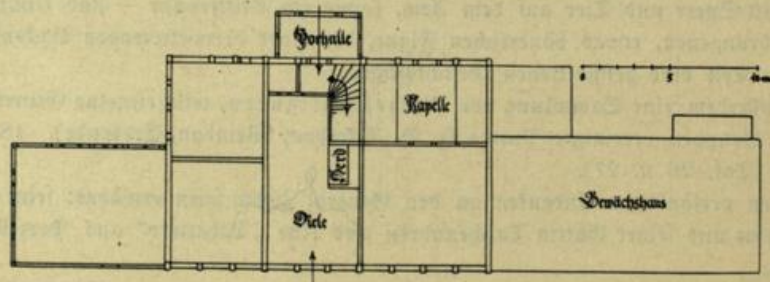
Busrau. Grundriß des Rohrschen Hauses.
